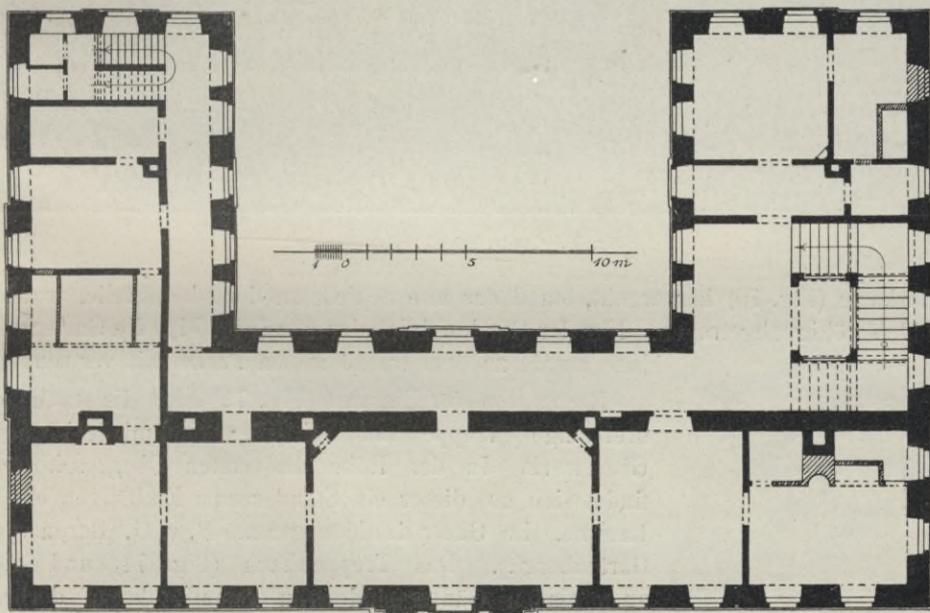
Canitz, Schloß, Grundriß des Obergeschosses.
